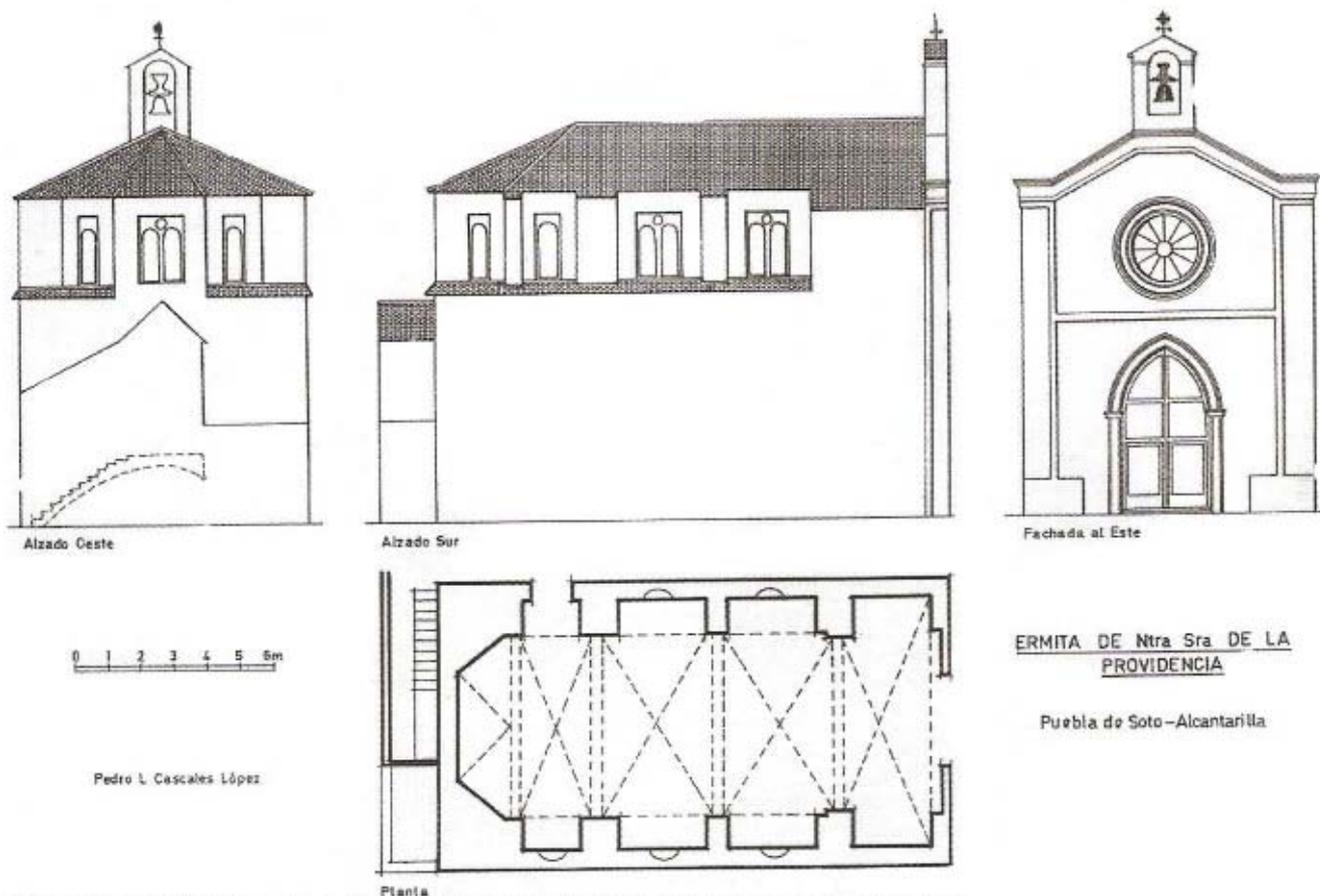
Planta y alzados de la ermita de Nuestra Señora de la Providencia
